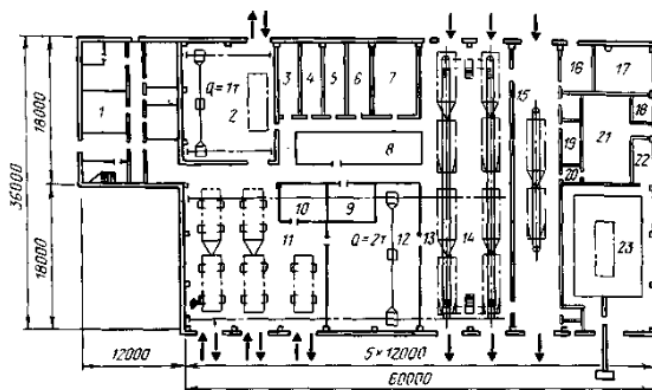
Планировка производственного корпуса на 100 грузовых автомобилей:
